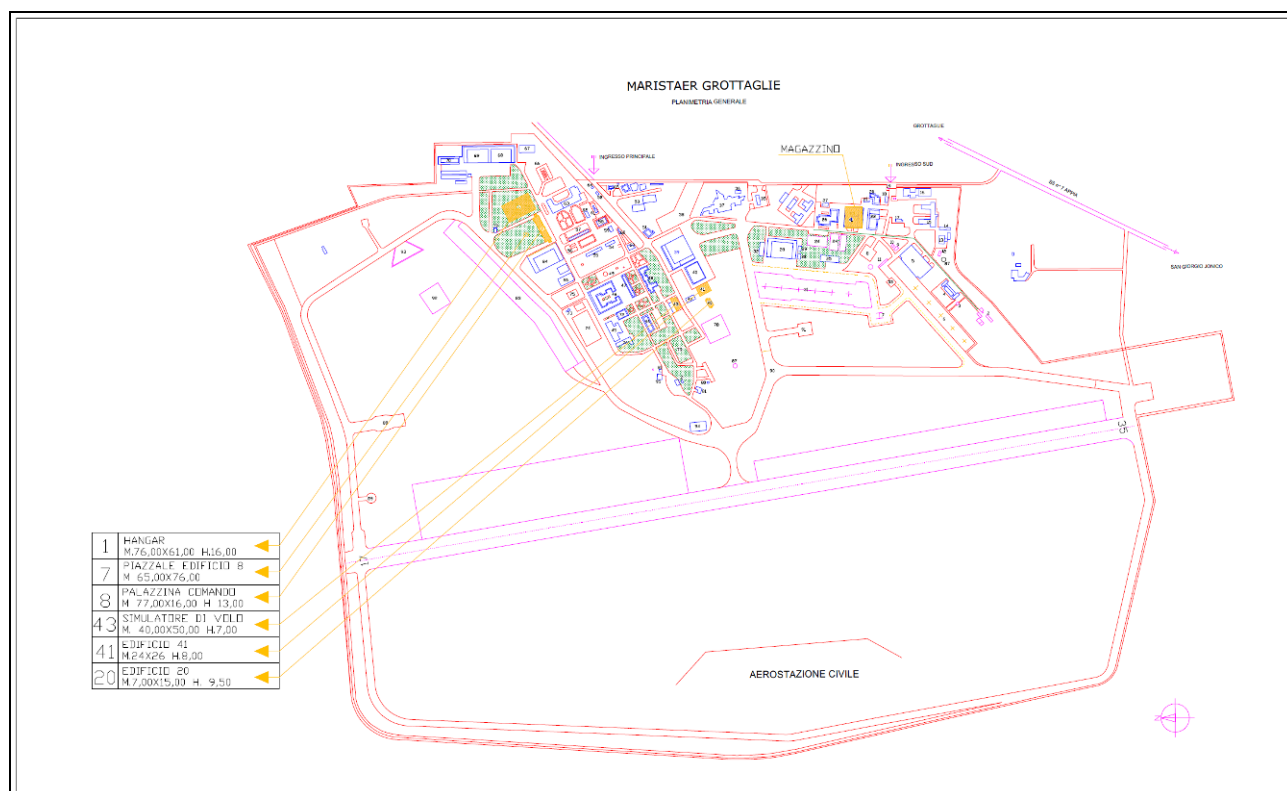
Planimetria con ubicazione delle opere di progetto.
